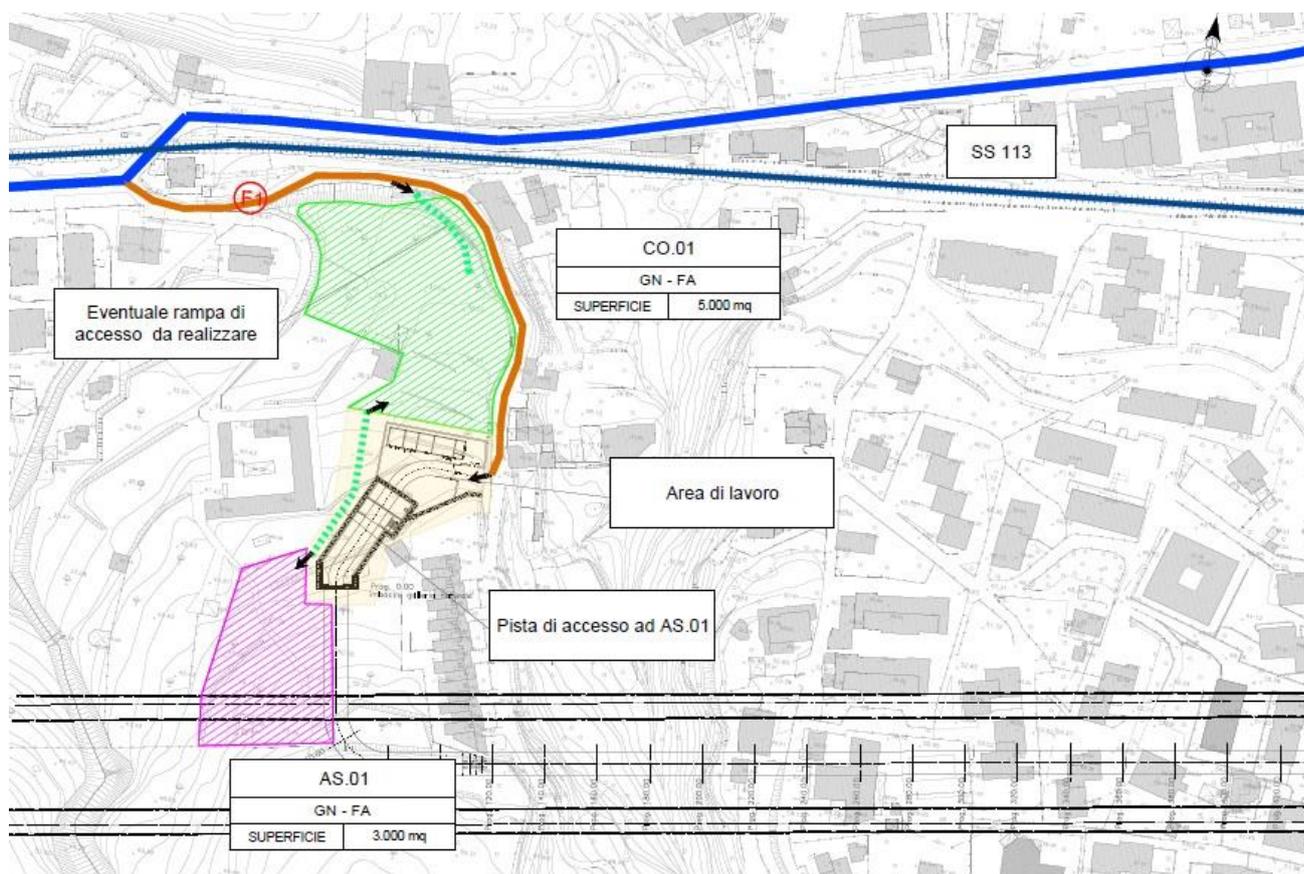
Planimetria dei cantieri e viabilità di accesso alle aree di cantiere (in verde pista di cantiere)
